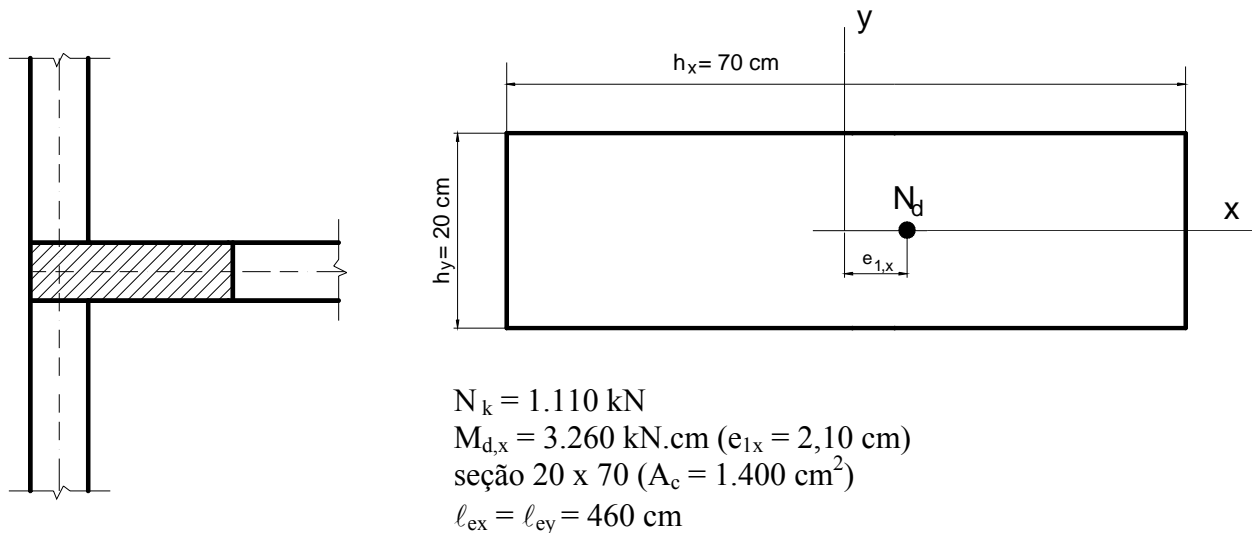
Arranjo estrutural do pilar na planta de fôrma e dimensões da seção.
